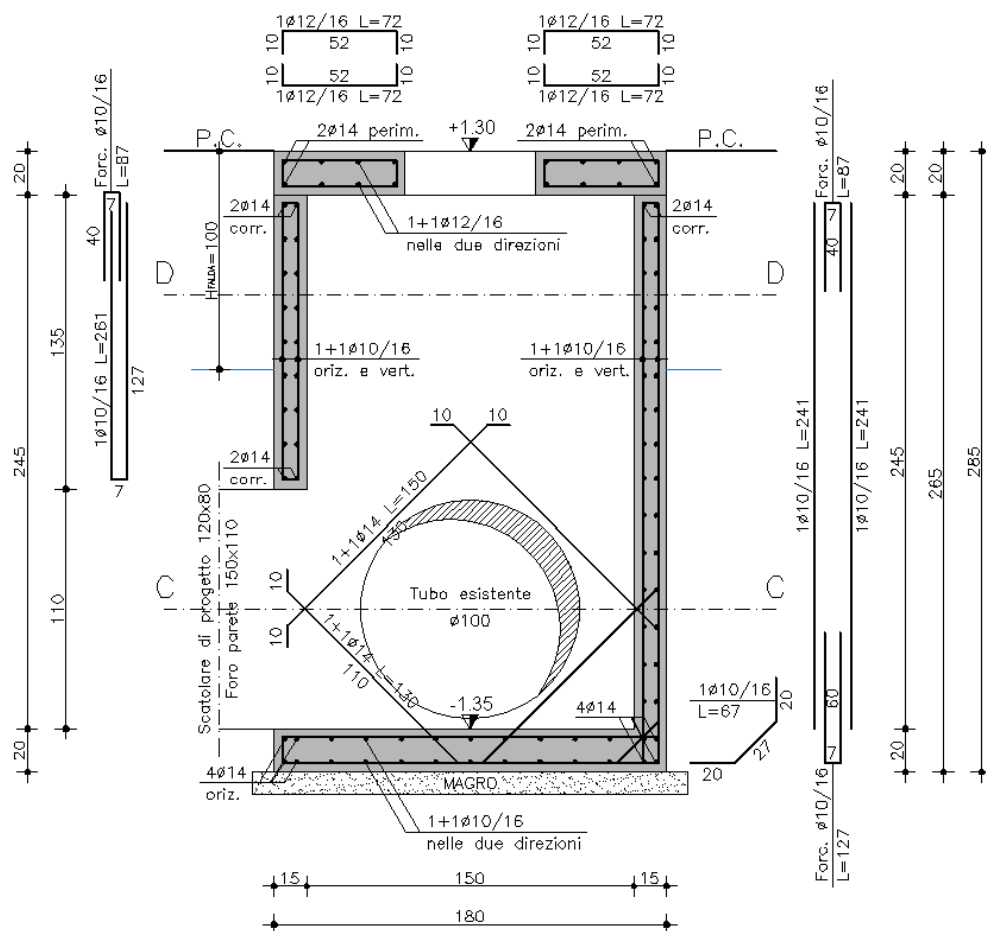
Pozzetto n. 1 - Sezione verticale A-A
